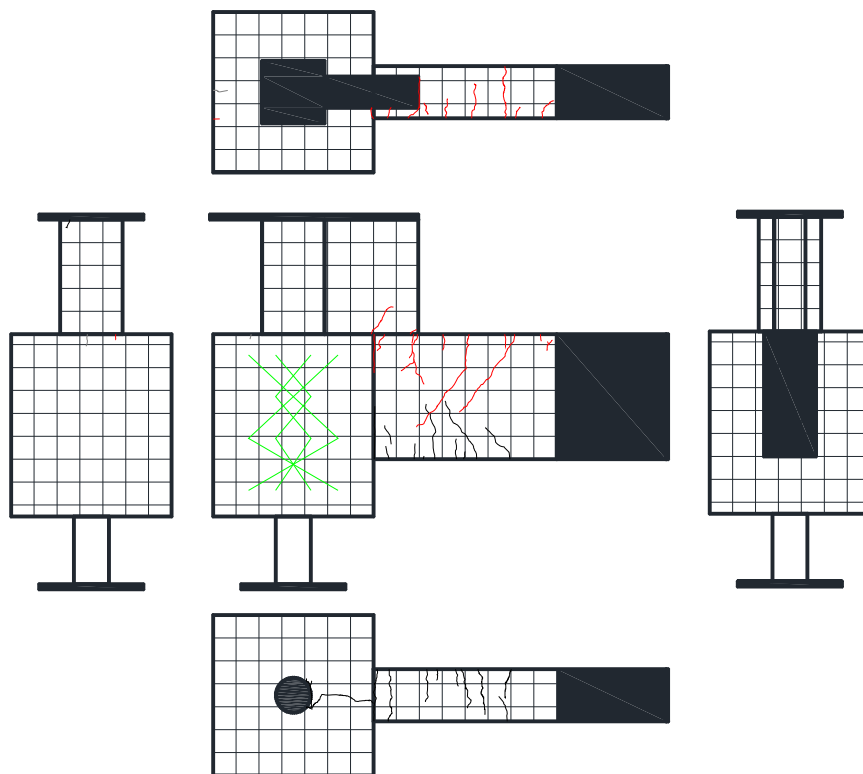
試験体 DR-2 ひび割れ状況 (1Cycle)
